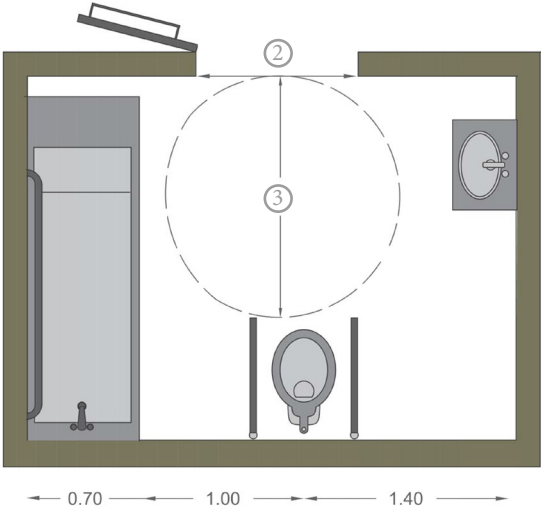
3 Baño con dos áreas de transferencia - Planta
